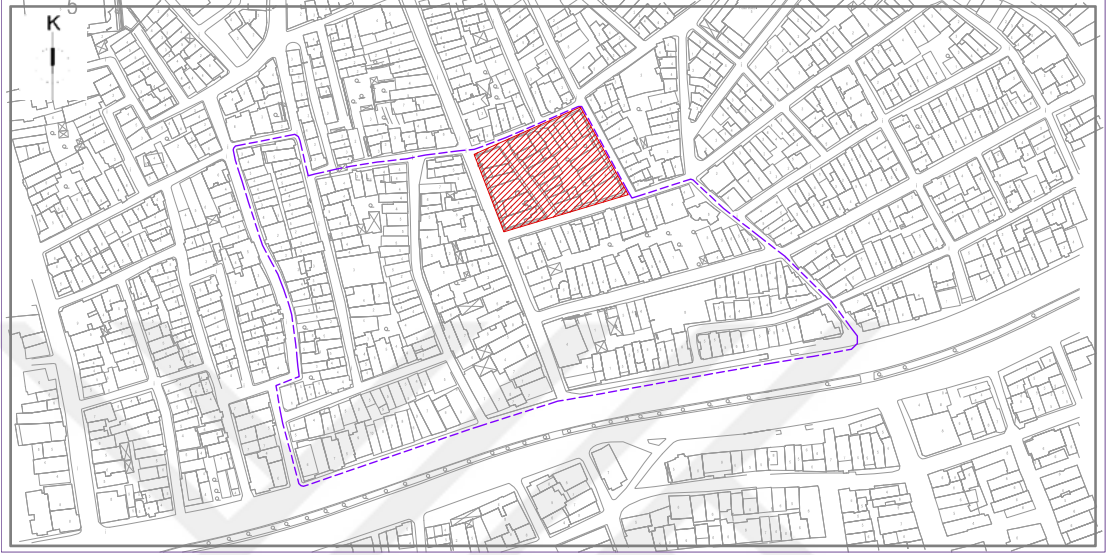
387 ada, 2007 onaylı avan projenin vaziyet planı. [4]
